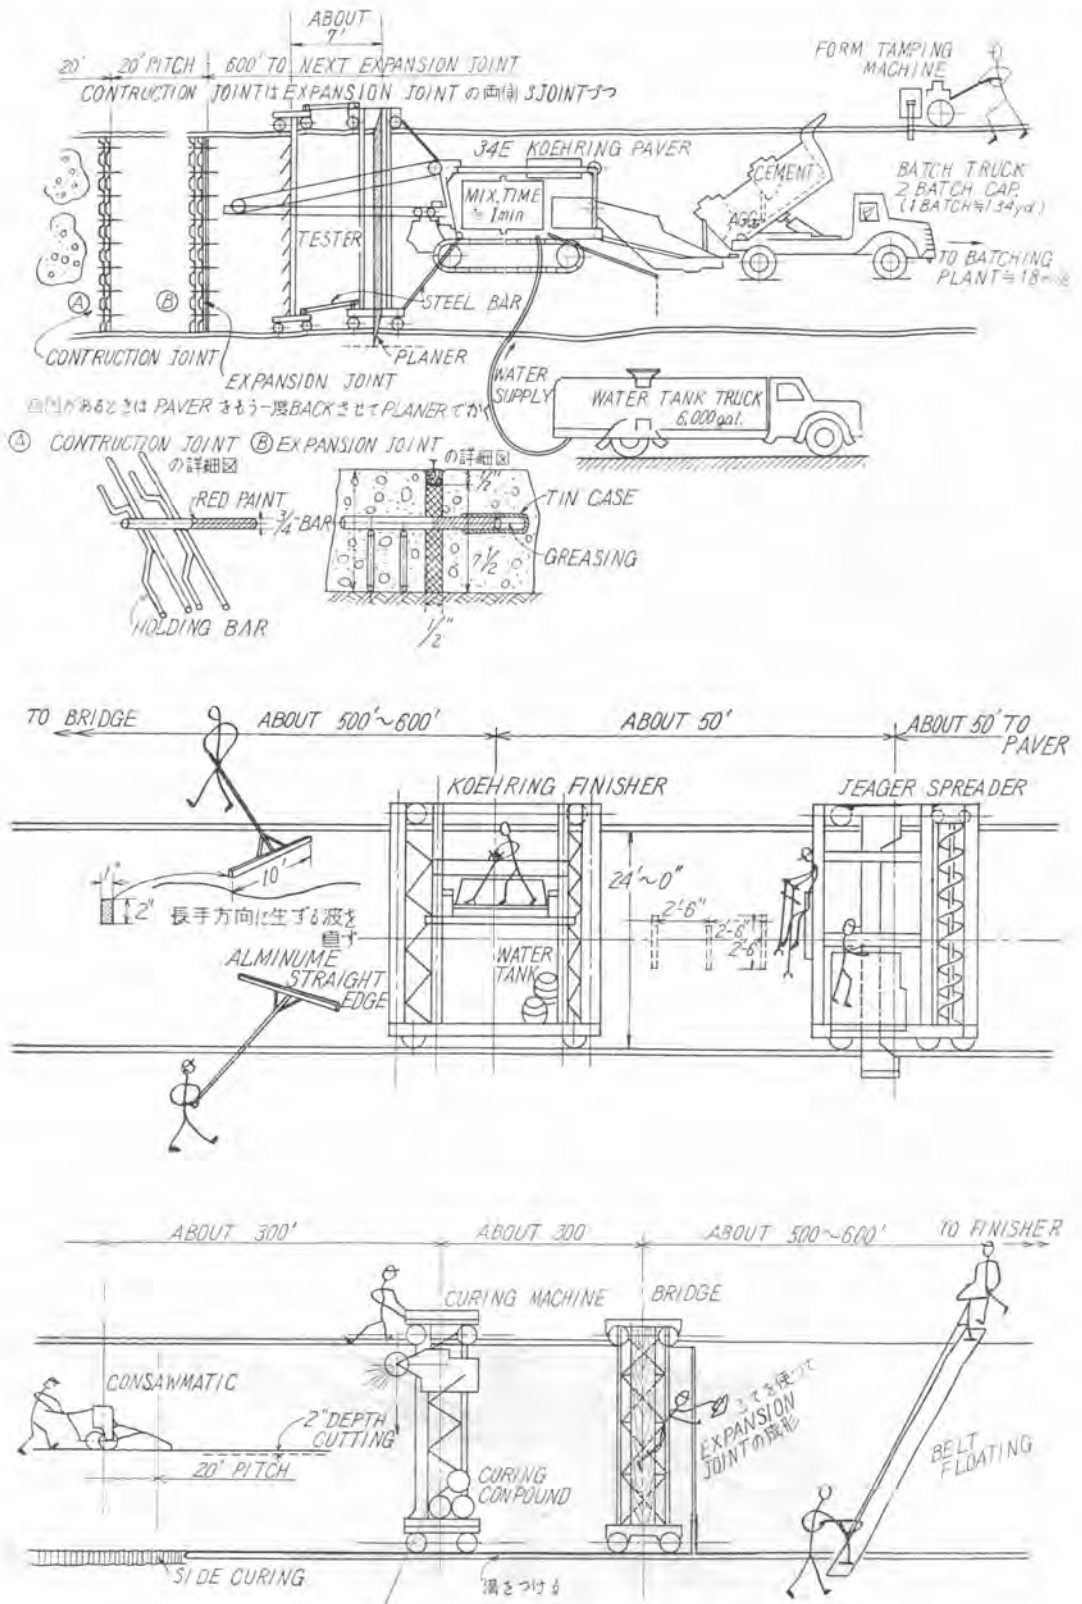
Paving Job for Florida State High Way 17 Jan. 1957 (St. Petersburg)
